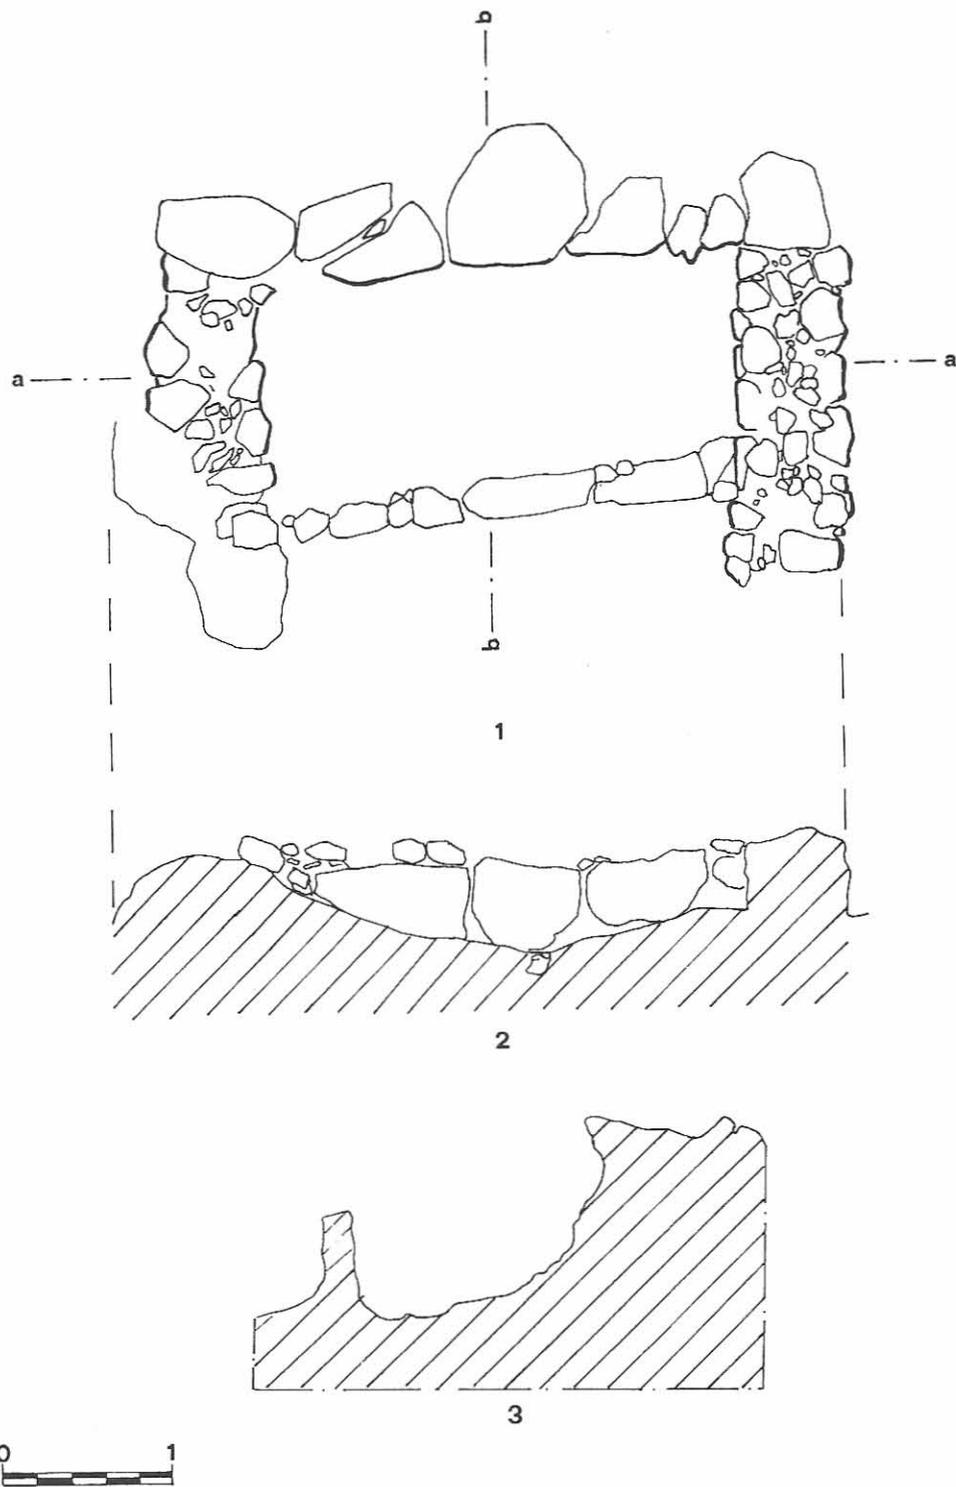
Pilón de la dependencia 2 del edificio D. nº 1.- planta; nº 2.- sección A-A: alzado del murete de cierre frontal de dicho pilón; nº 3.- sección B-B: interior del pilón.
